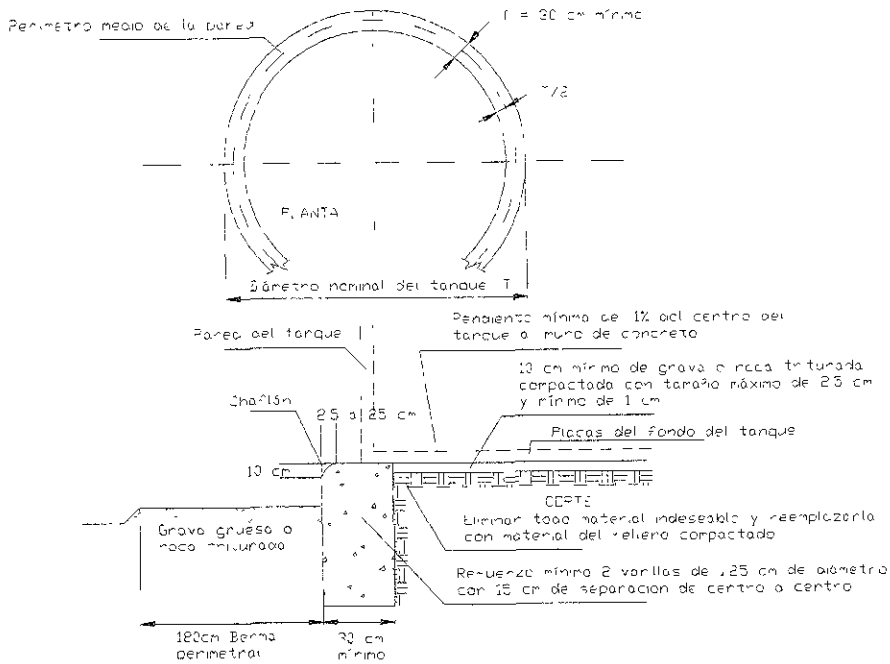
a Cimentación sobre muro anular de concreto
